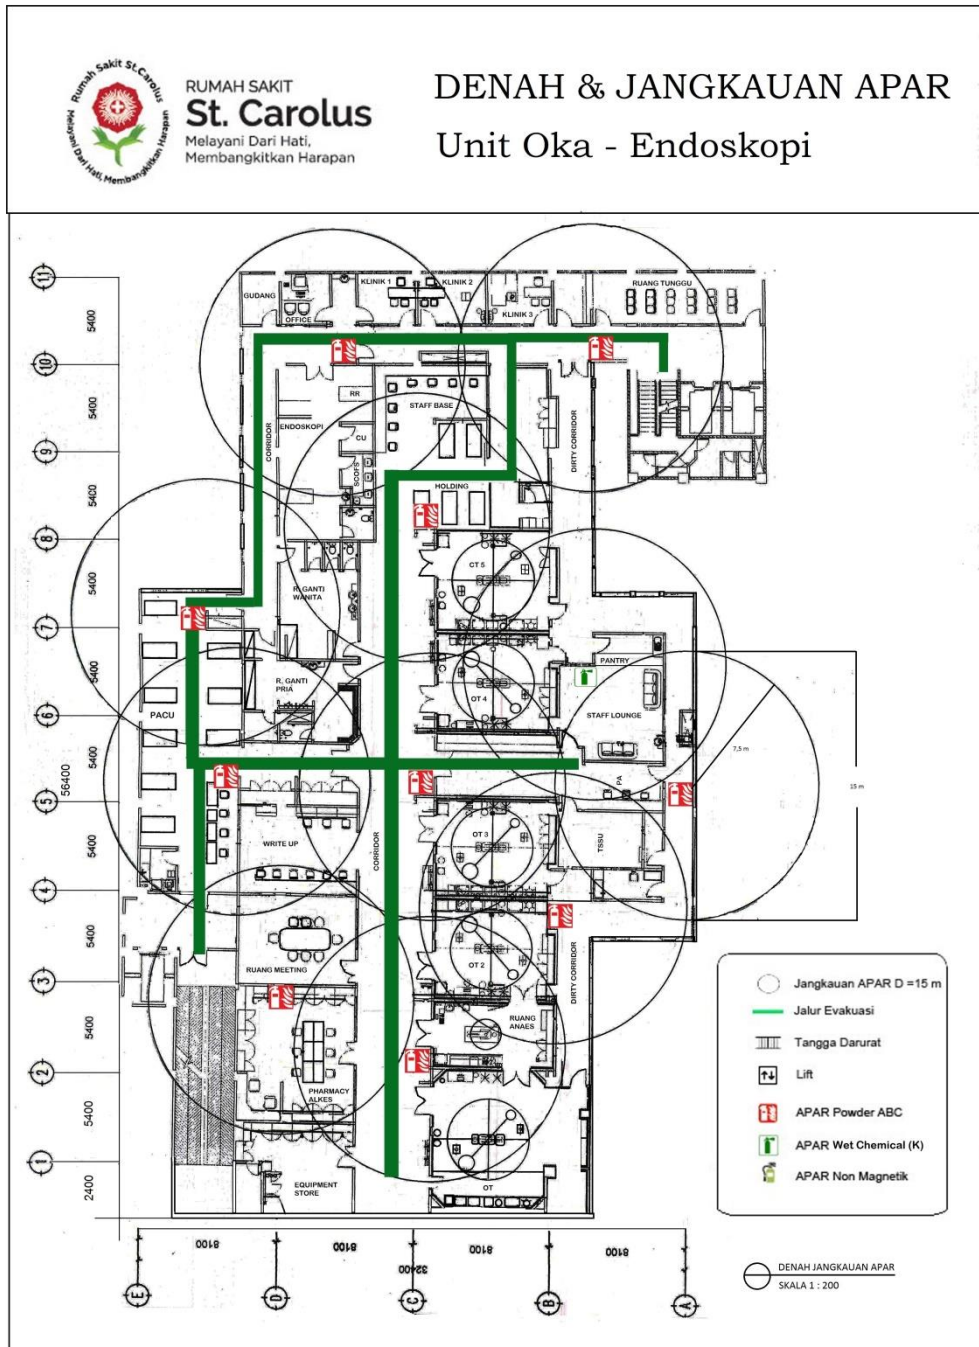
Denah Jangkauan APAR Lantai 1
